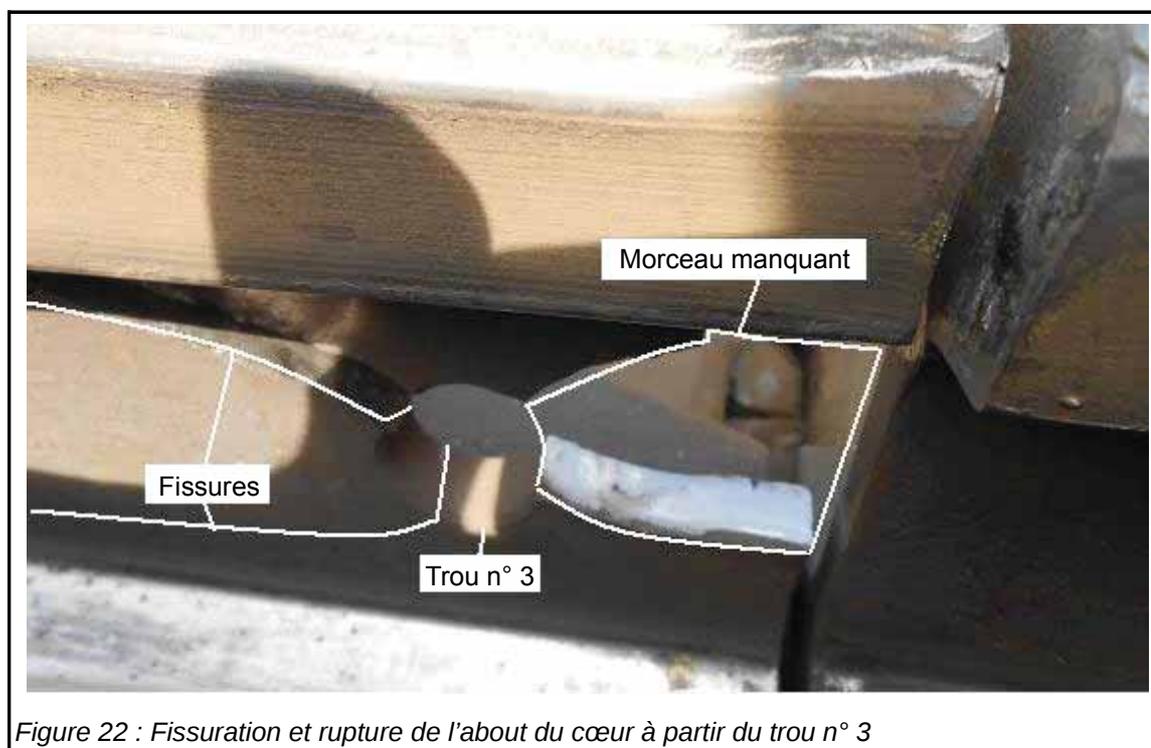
Fissuration et rupture de l'about du cœur à partir du trou n° 3
